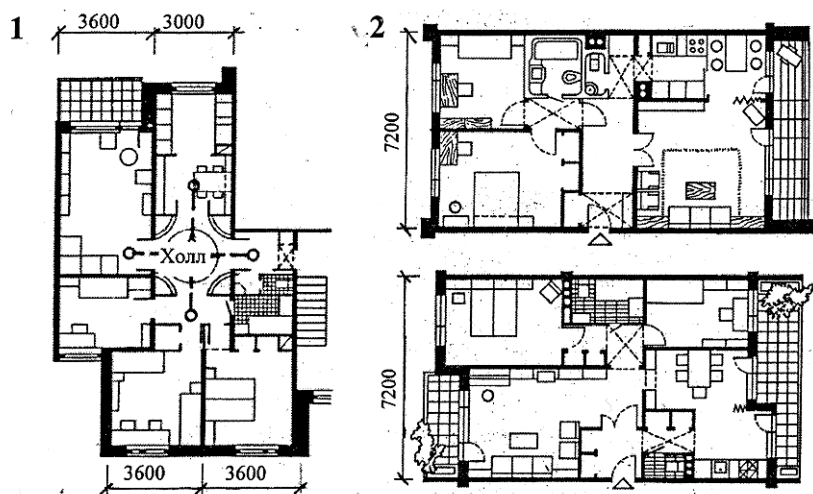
Примеры планировки квартир с двухсторонней ориентацией в крупнопанельных домах: 1 - с узким шагом несущих поперечных стен; 2 - с большим шагом несущих поперечных стен
